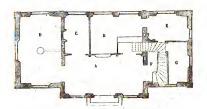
Station de Champigny. Rez-de-chaussée.
